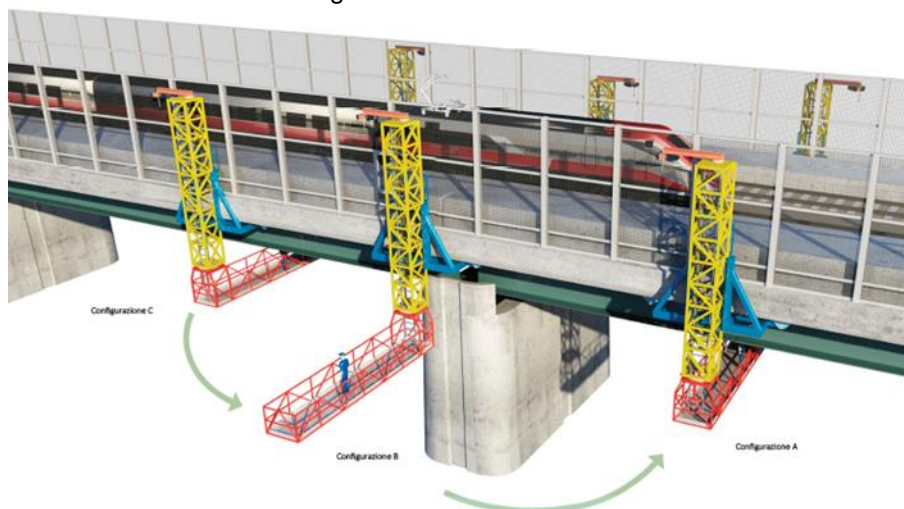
Schema funzionamento apertura/chiusura carrello in corrispondenza pile
